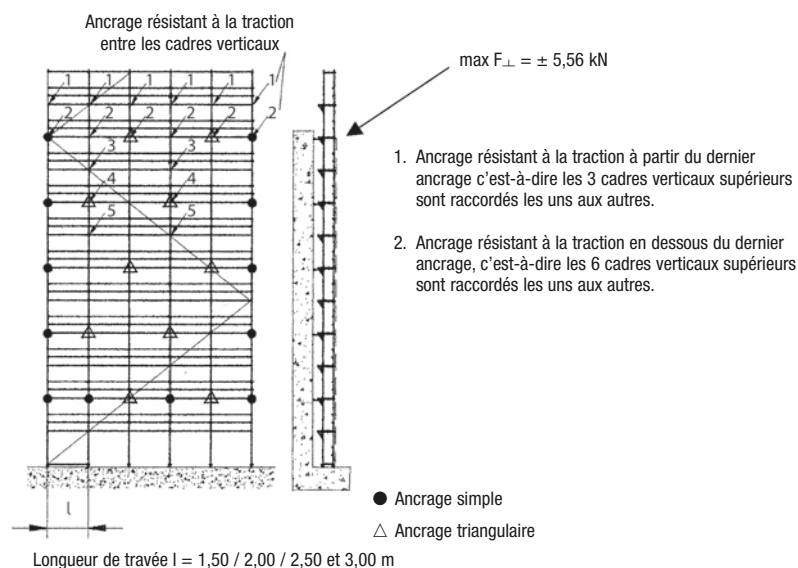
Etages d'échafaudage libres au-dessus du dernier ancrage; échafaudage sans revêtement avec consoles intérieur devant façade ouverte
